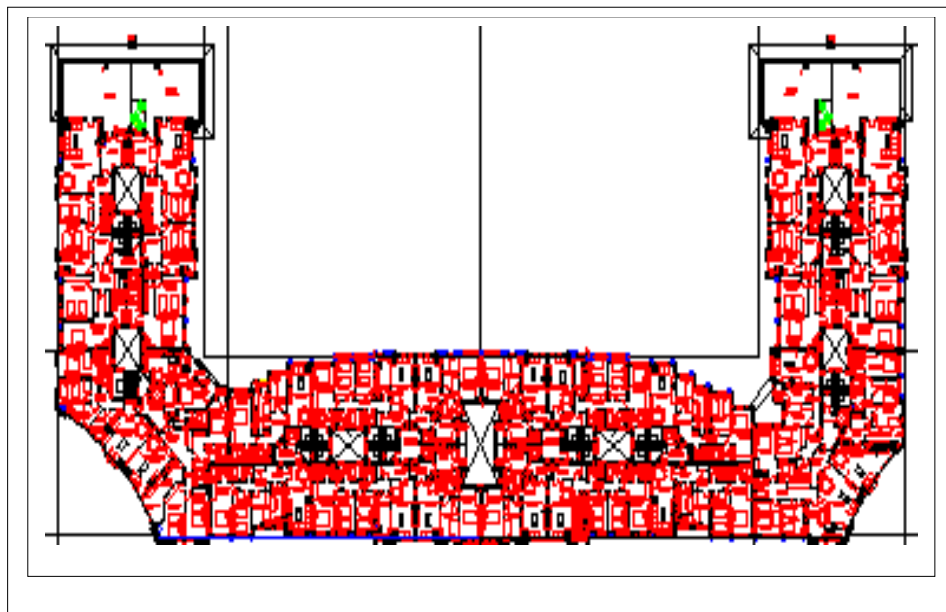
Vista en planta de la planta 7ª. Fuente: Departamento de Ingeniería Térmica y de Fluidos, Universidad Carlos III de Madrid.
